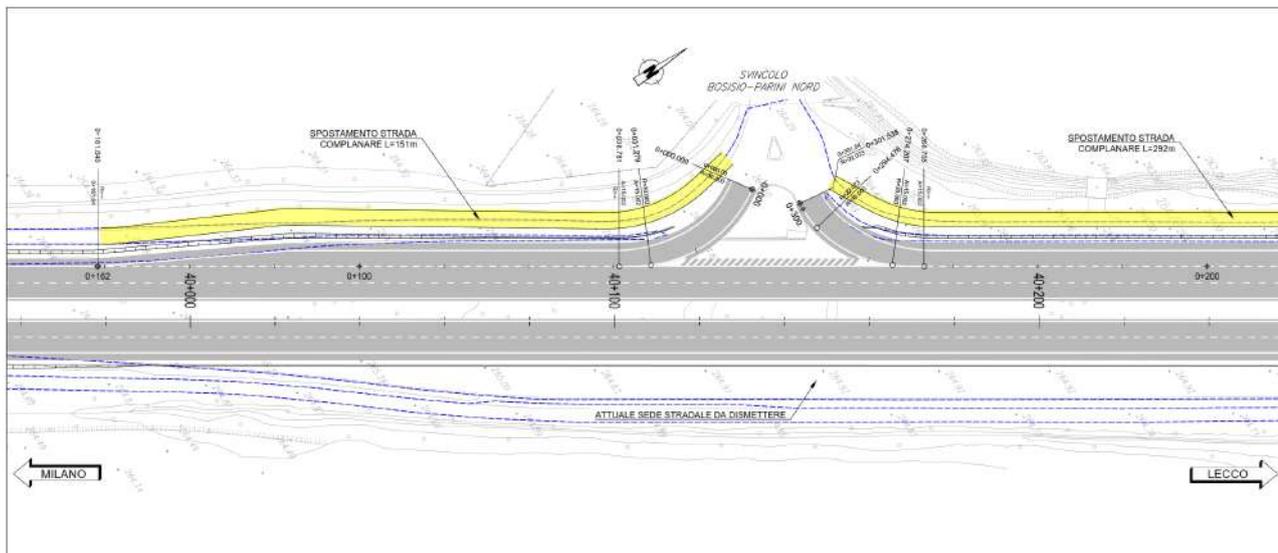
Stralcio planimetrico soluzione progettuale dello svincolo Bosisio Parini Nord
